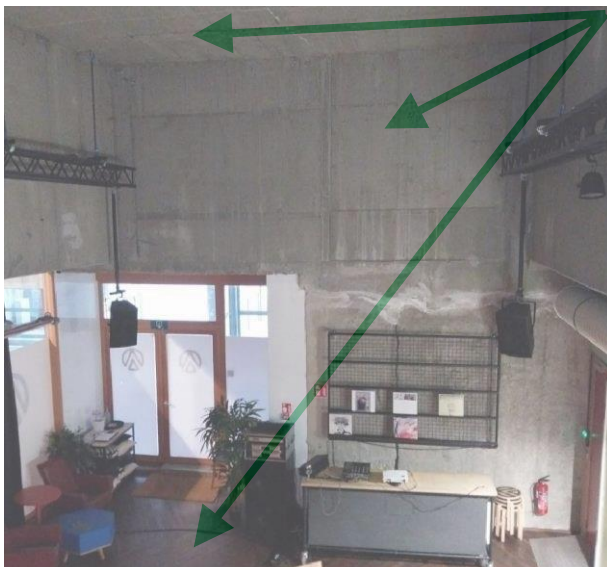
00.23 opslag: betonnen vloer en plafond, technische dranken installatie: geen asbest
